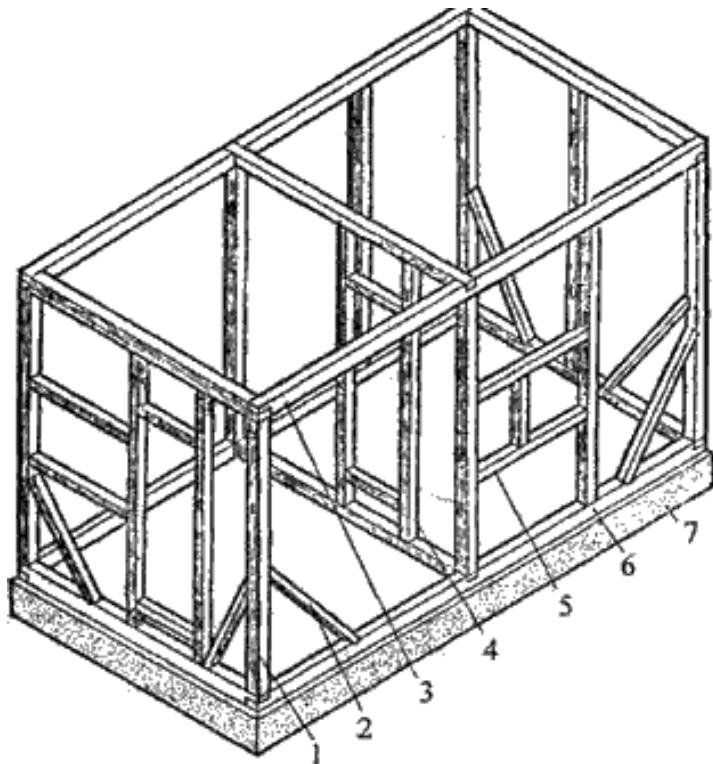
Каркас стен из бруса: 1 — стойка; 2 — раскос; 3 — балка верхней обвязки; 4 — дополнительная стойка для дверной коробки; 5 — продольный брус; 6 — балка нижней обвязки; 7 — фундамент.
